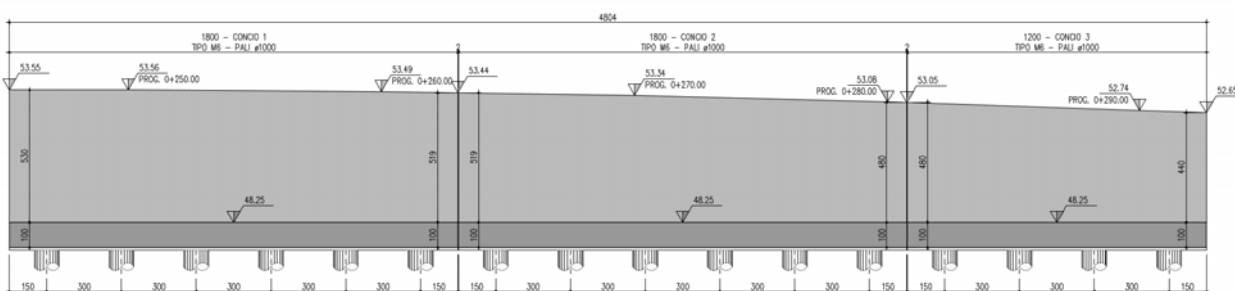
viste e sezioni principali – prospetto longitudinale
